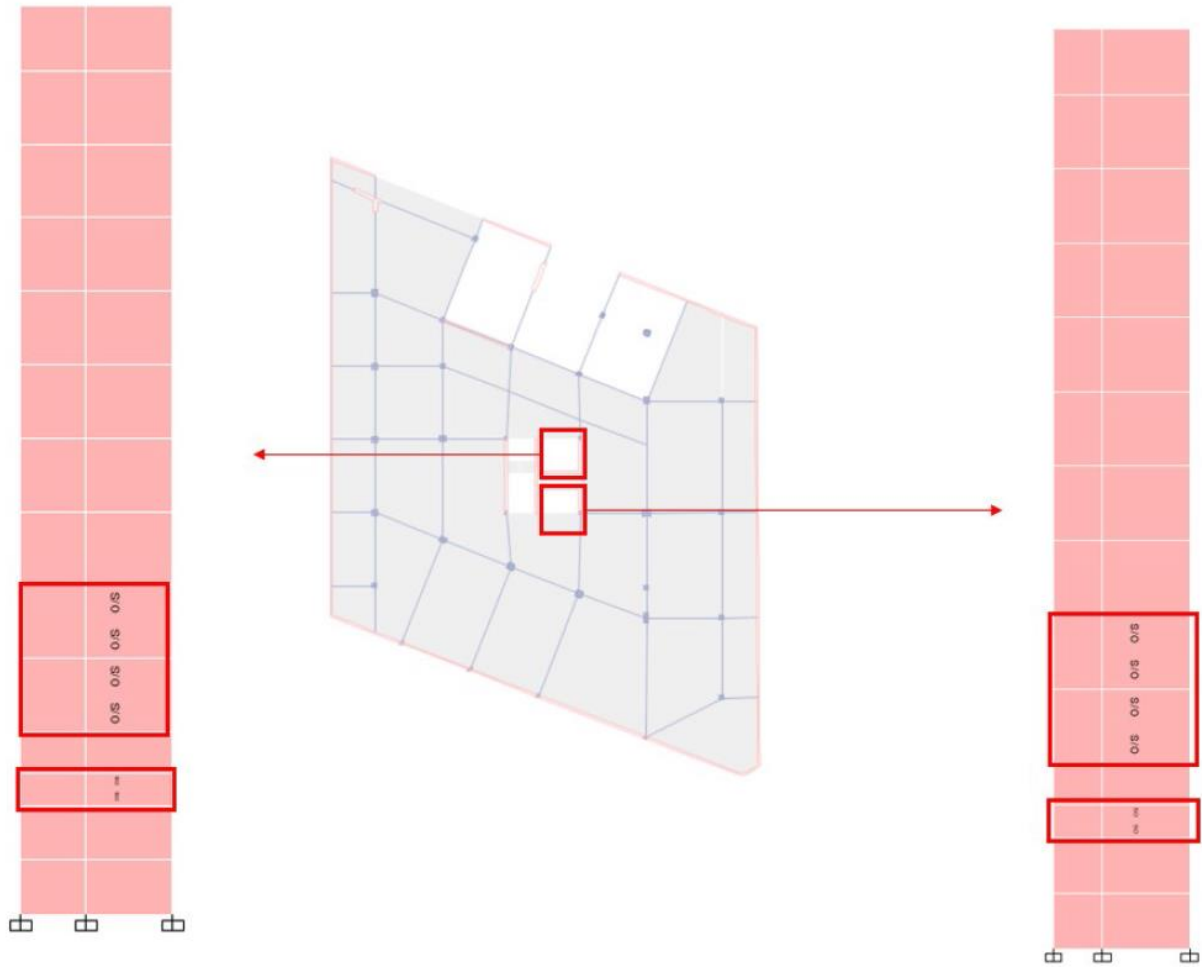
Ubicaciones de columnas a reforzar en los niveles 7 a 9
